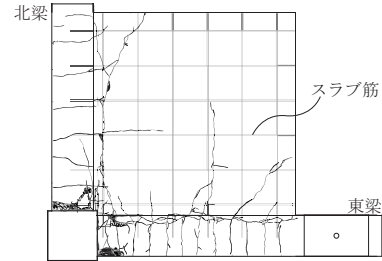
スラブ上面のひび割れ状況（実験終了時）
